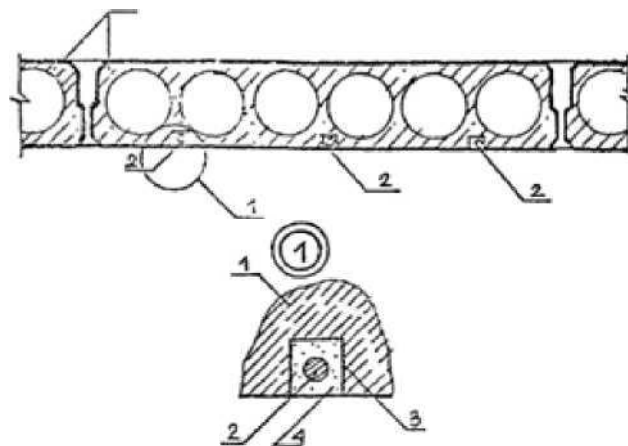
Устройство дополнительной арматуры на полимеррастворе: 1- усиливаемые плиты; 2-дополнительная арматура; 3-пазы в бетоне, вырезанные фрезой; 4- защитно-конструкционный полимерраствор.
